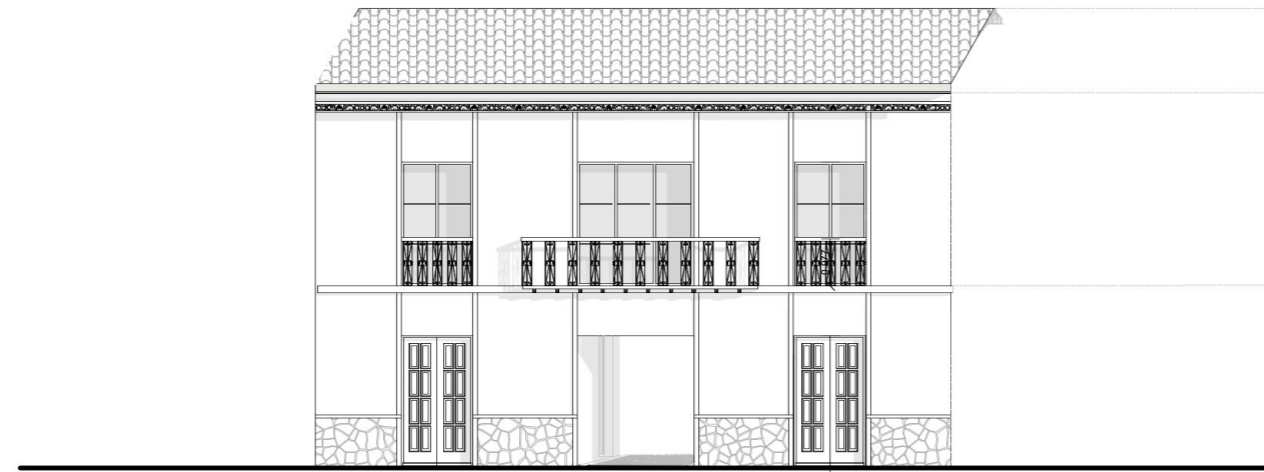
Alz A. Alzado Calle Tarqui. Autoría propia.
